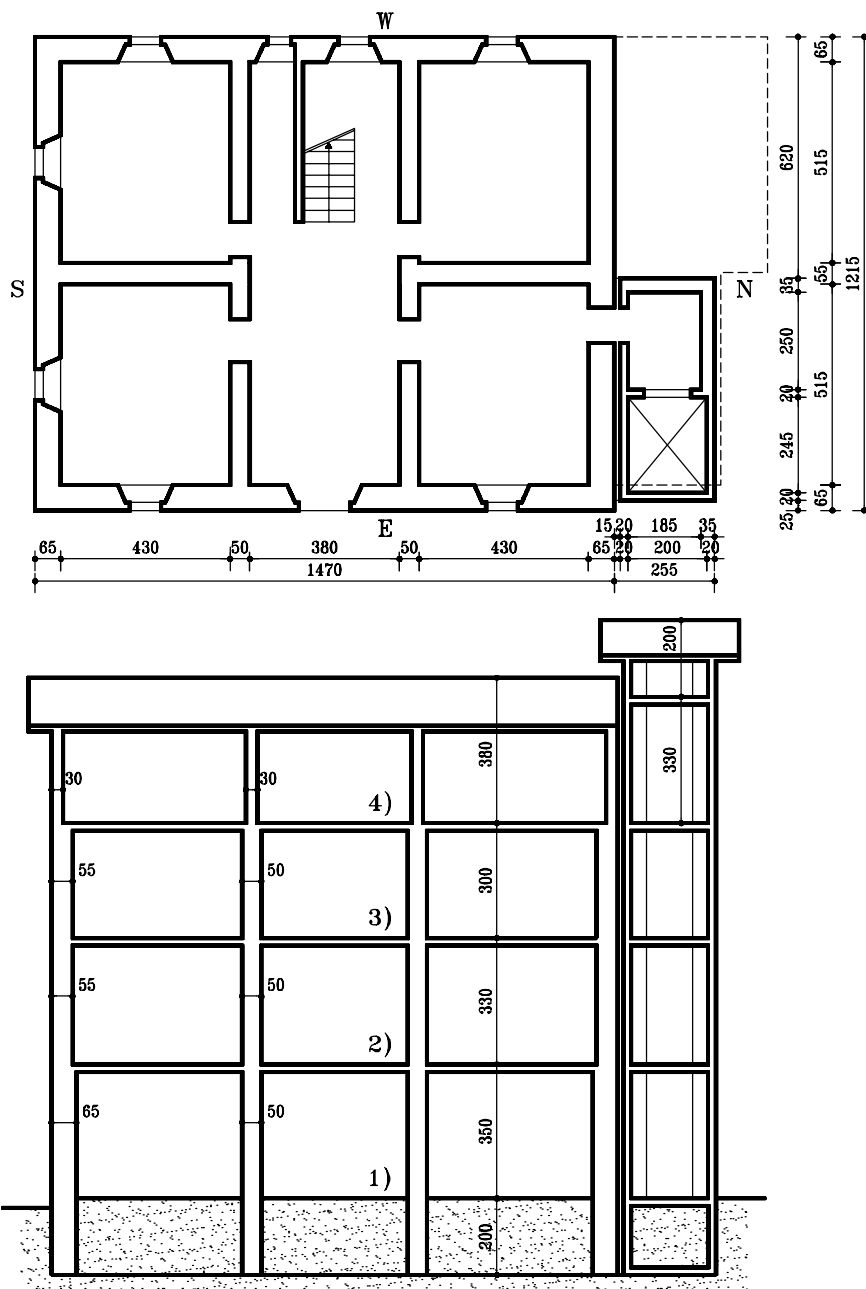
Pianta tipo e sezione verticale (quote in cm)
